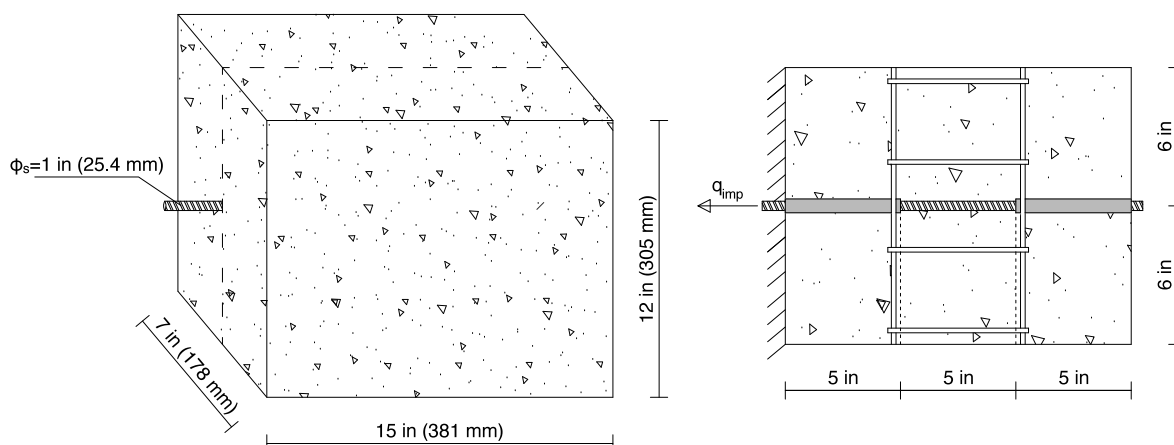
Configuração do ensaio (adaptado de Eligehausen et al. [33] e Mendes e Castro [6])
